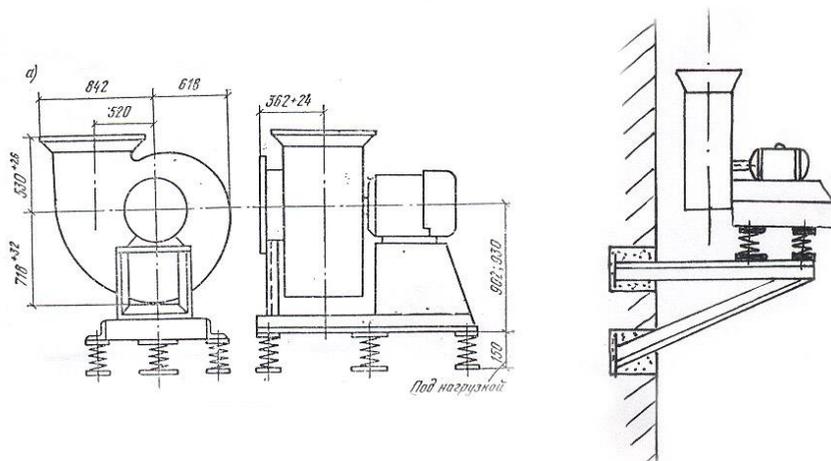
Установка вентилятора на виброизоляторы и металлоконструкцию
